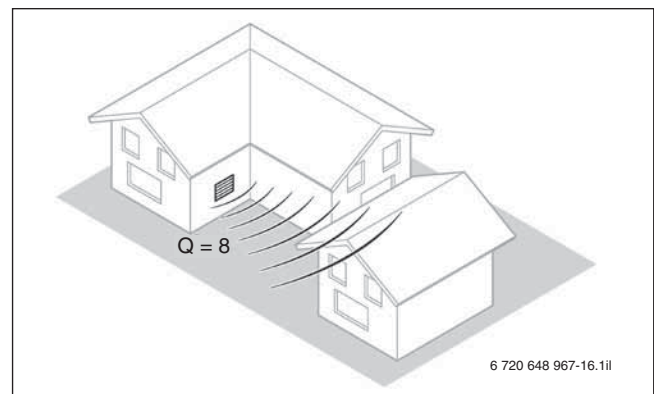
Wärmepumpe oder Lufteinlass/Luftauslass (bei Innenaufstellung) an einer Hauswand bei einspringender Fassadenecke, Abstrahlung in den Achtelraum (Q = 8); Bildquelle: „Leitfaden Schall“ des bwp e.V.
